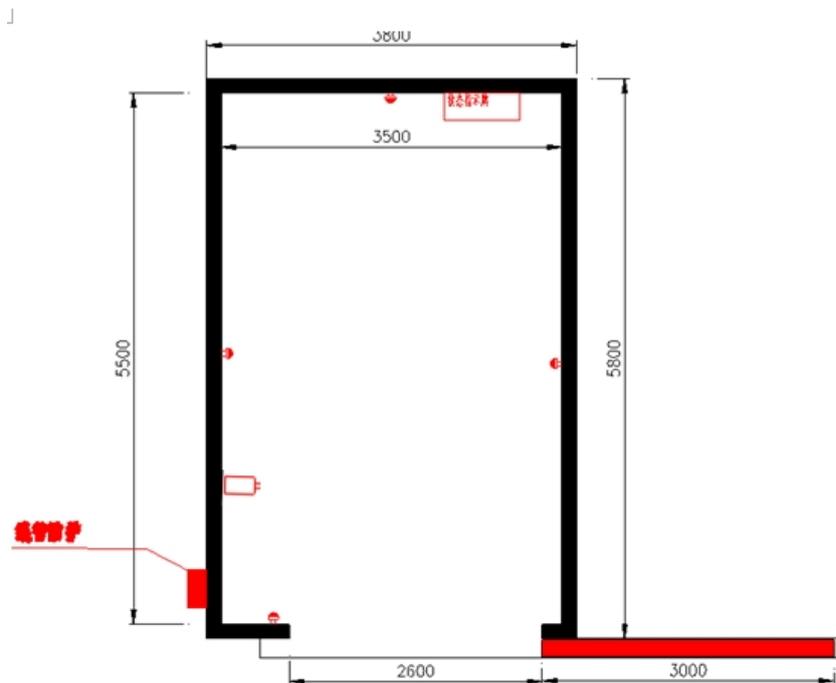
探伤铅房拟采取的部分辐射安全和防护措施平面布置图
